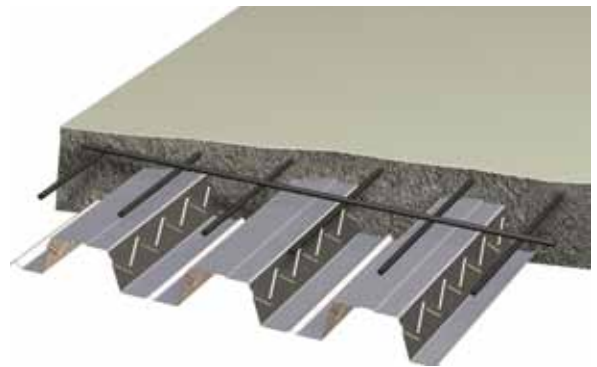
Сталебетонное перекрытие разработки Группы предприятий «Стальные конструкции»
